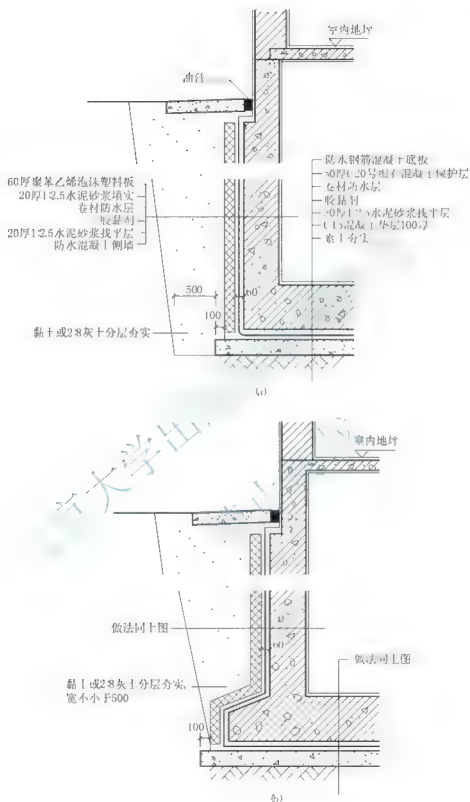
防水混凝土及外包柔性防水做地下室的防水构造
